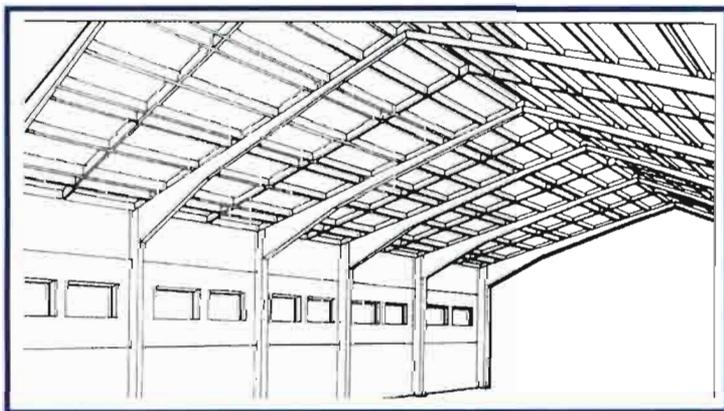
Estructura de nave de cebo de hormigón prefabricado.
